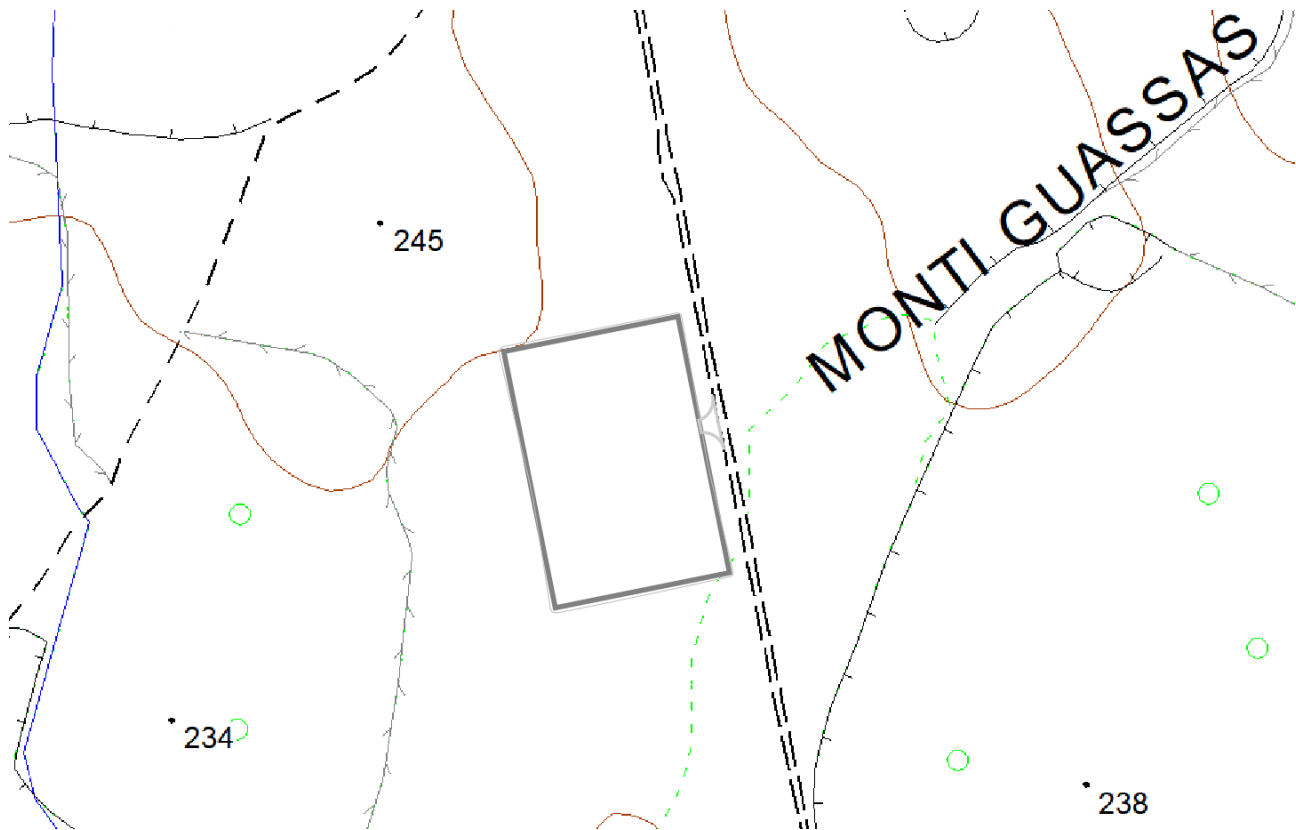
Superficie di spianamento dell'area di cantiere e strada di accesso su CTR
